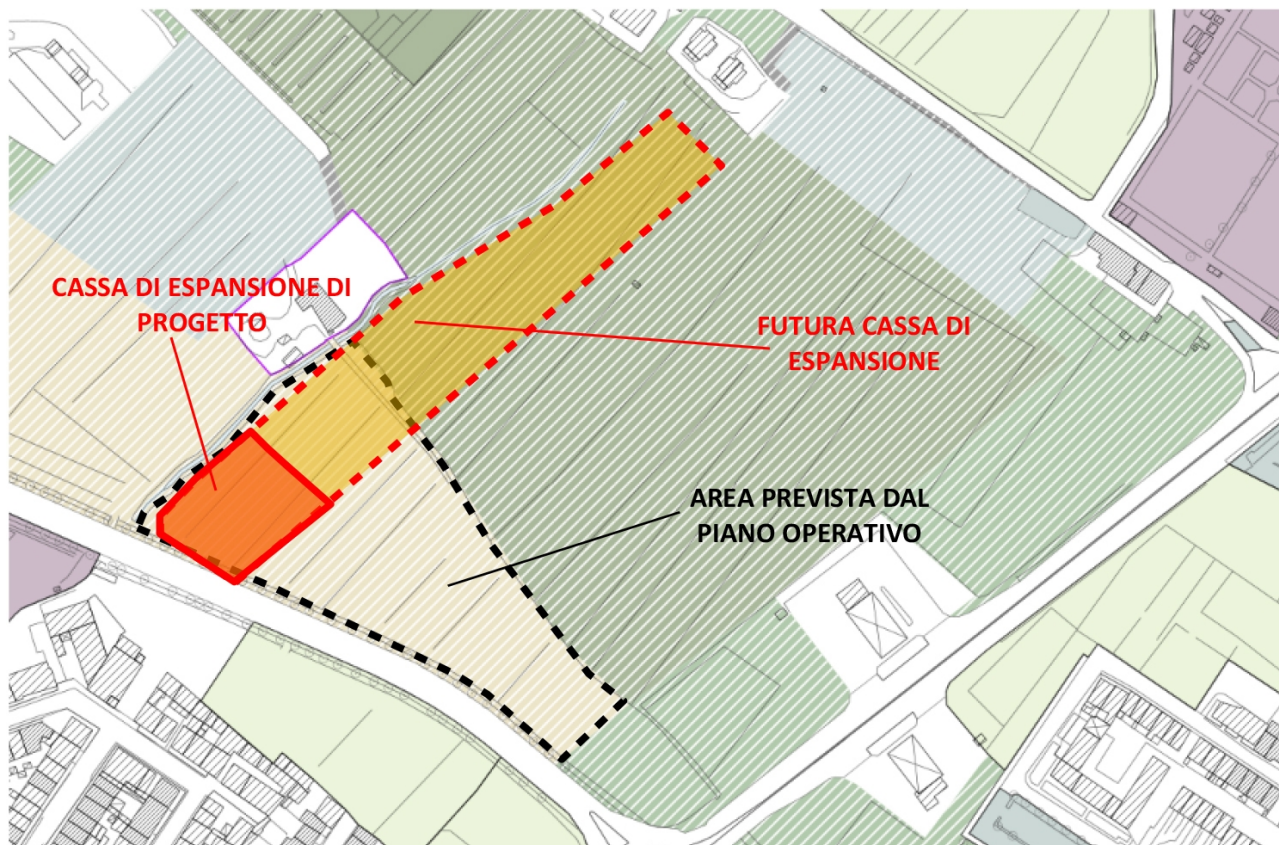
Modifica planimetrica dell'area da destinare alla realizzazione dell'opera di regimazione idraulica
